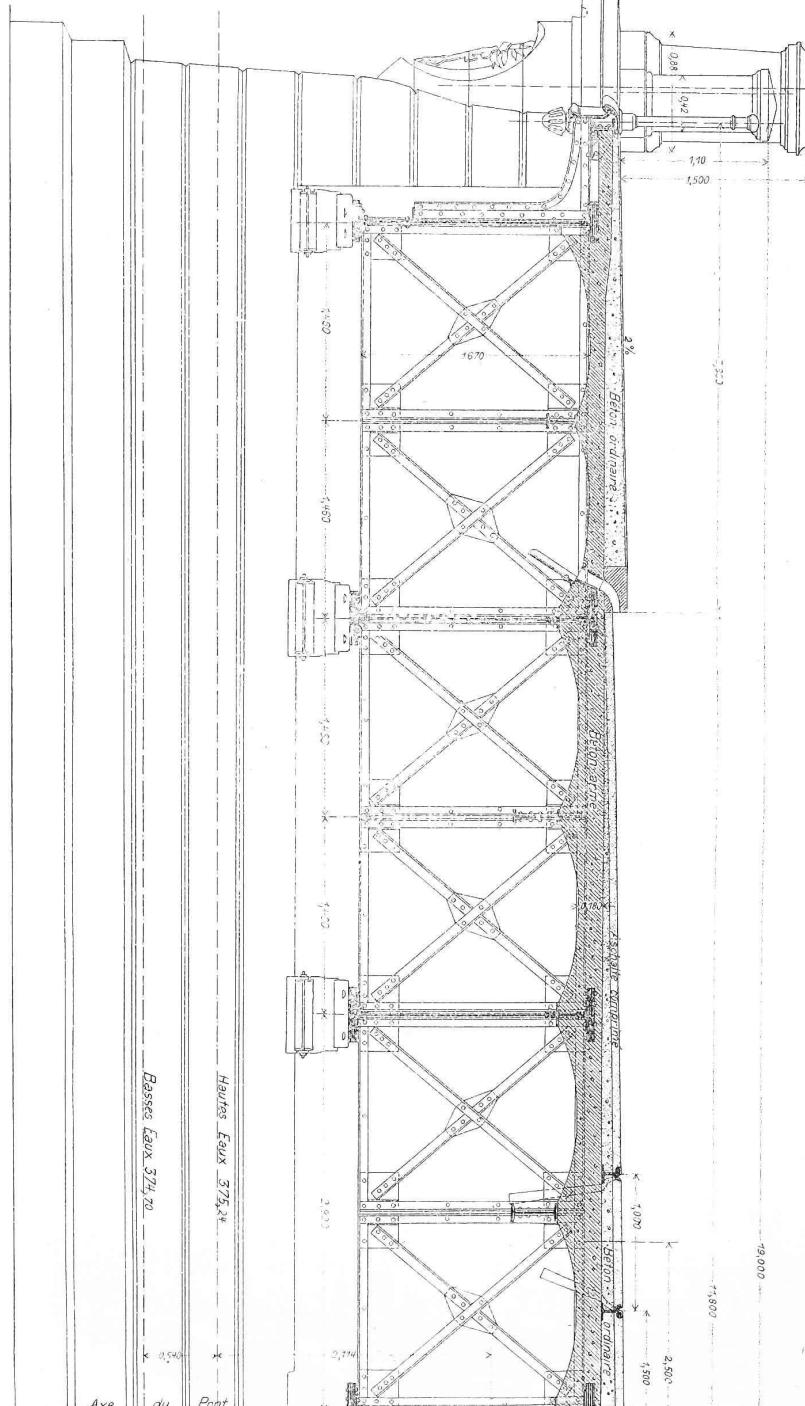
Coupe en travers au droit d'une pile. — Echelle 1 : 50.
